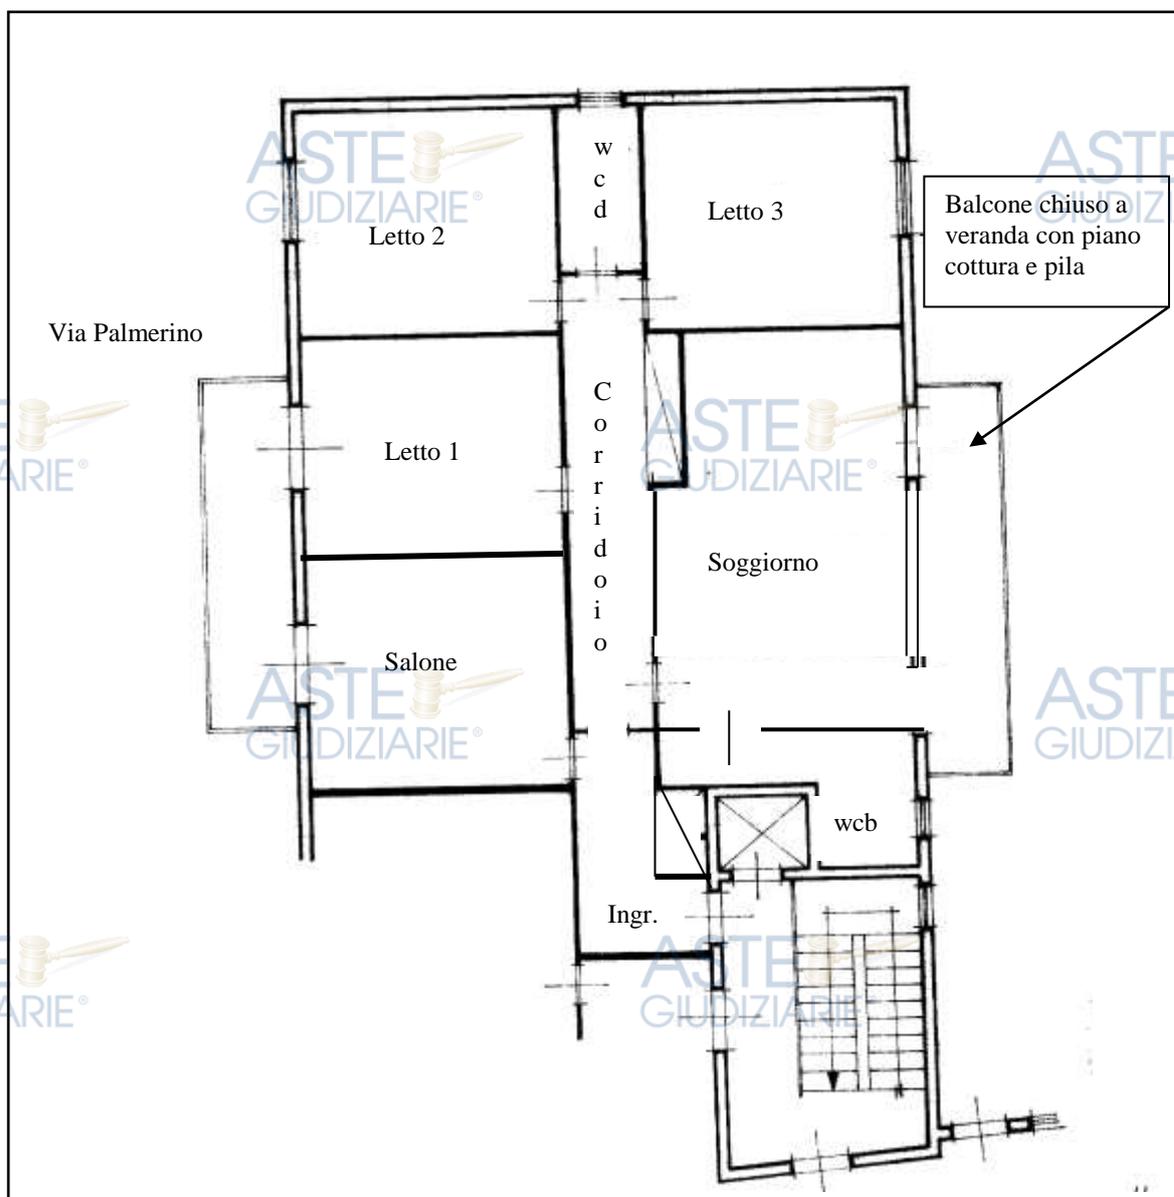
Planimetria rappresentativa dello stato di fatto dell'appartamento
